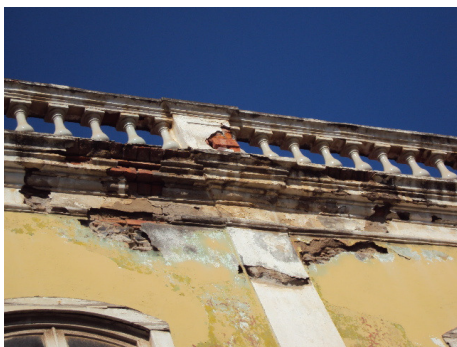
Alçado Lateral . Fissuras na parede exterior . 2010.
